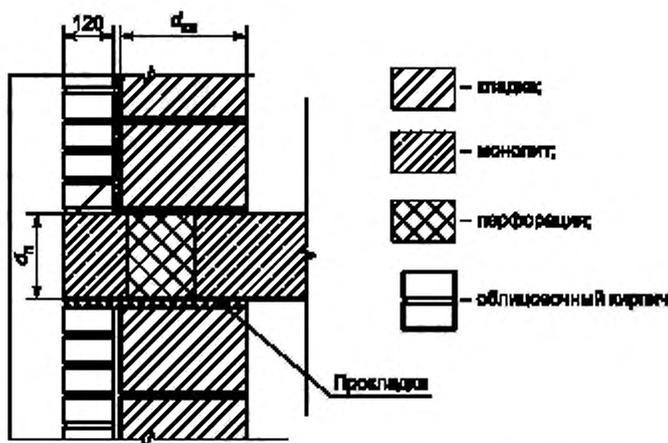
Схема узла сопряжения плиты перекрытия с наружной стеной
